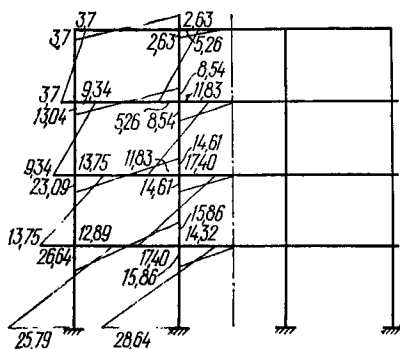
Эпюры изгибающих моментов в раме здания от ветровой нагрузки
